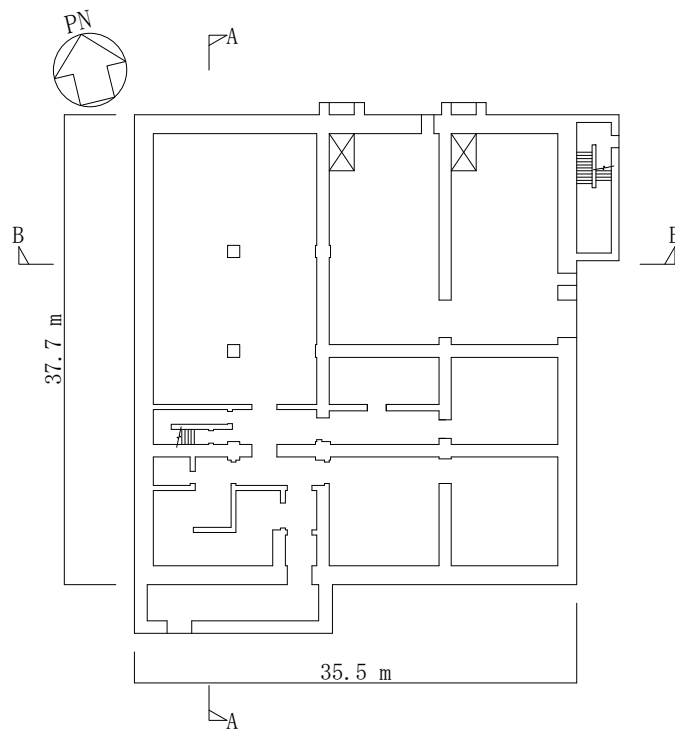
(1/5) 緊急時対策所建屋の概略平面図（1階平面図：EL. 23.3 m）
